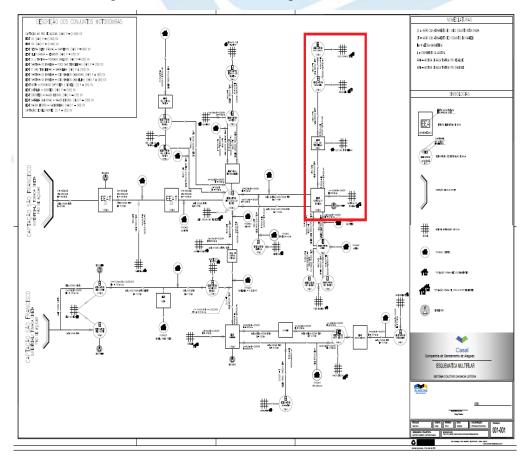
Planta Baixa do esquema da Bacia Leiteira
